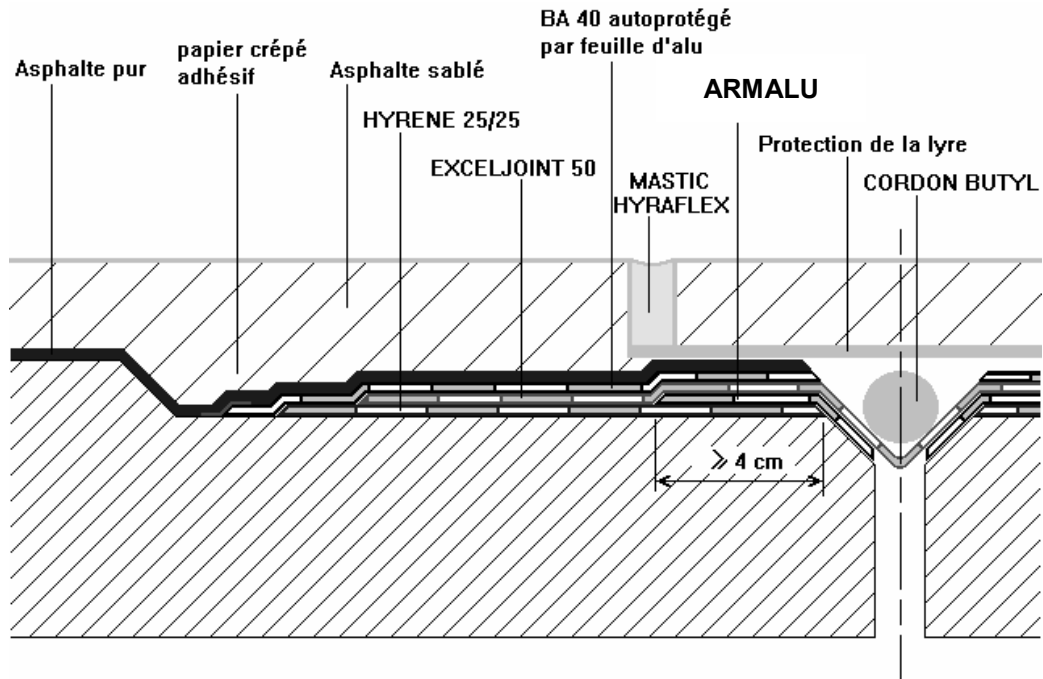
Joint plat raccordé à une étanchéité asphalte
